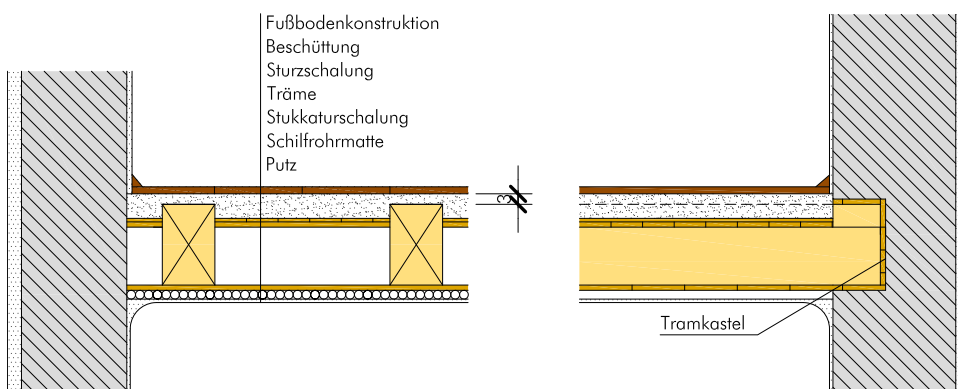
Tramdecke mit versenkter Sturzschalung [32]
